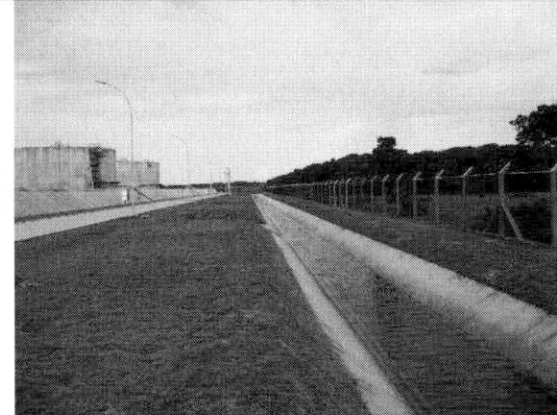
Vista do canal de drenagem de águas pluviais do TNC.
